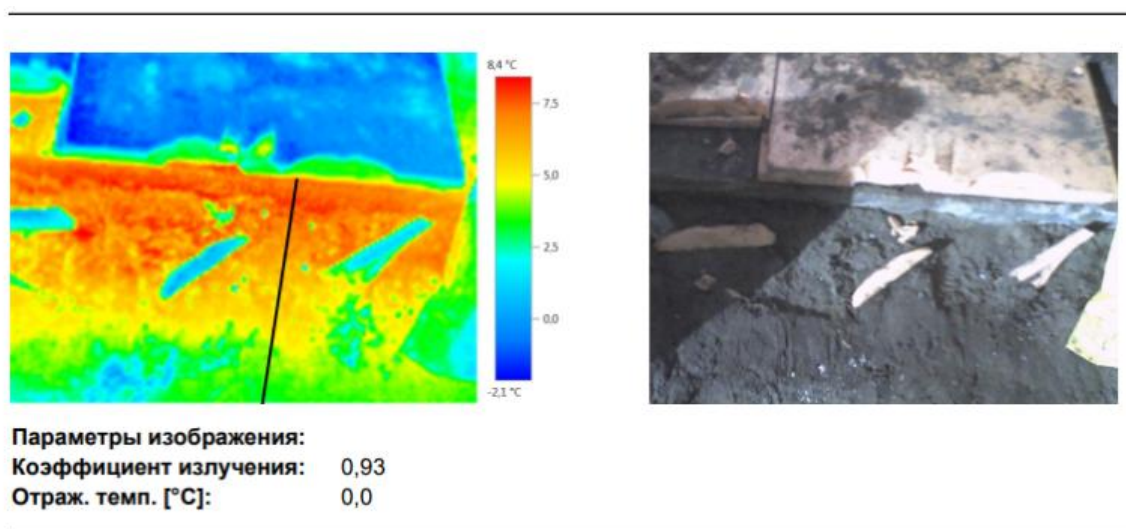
Температурные поля на поверхности грунта и фундамента наружной несущей стены здания, под теплоизоляцией (создано авторами)
